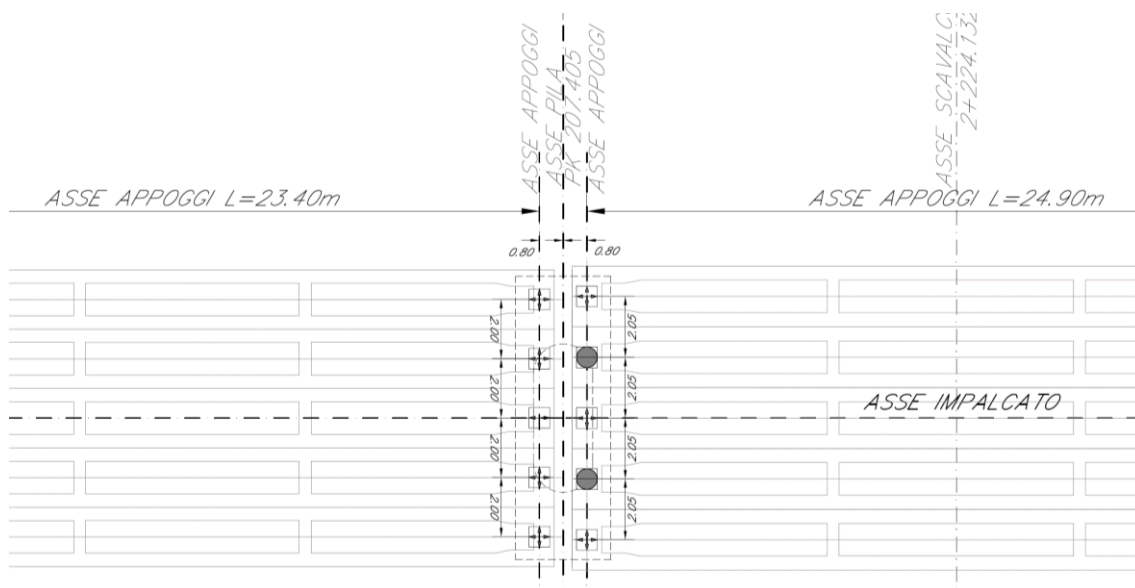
Pila 1 - Schema dei dispositivi di appoggio
